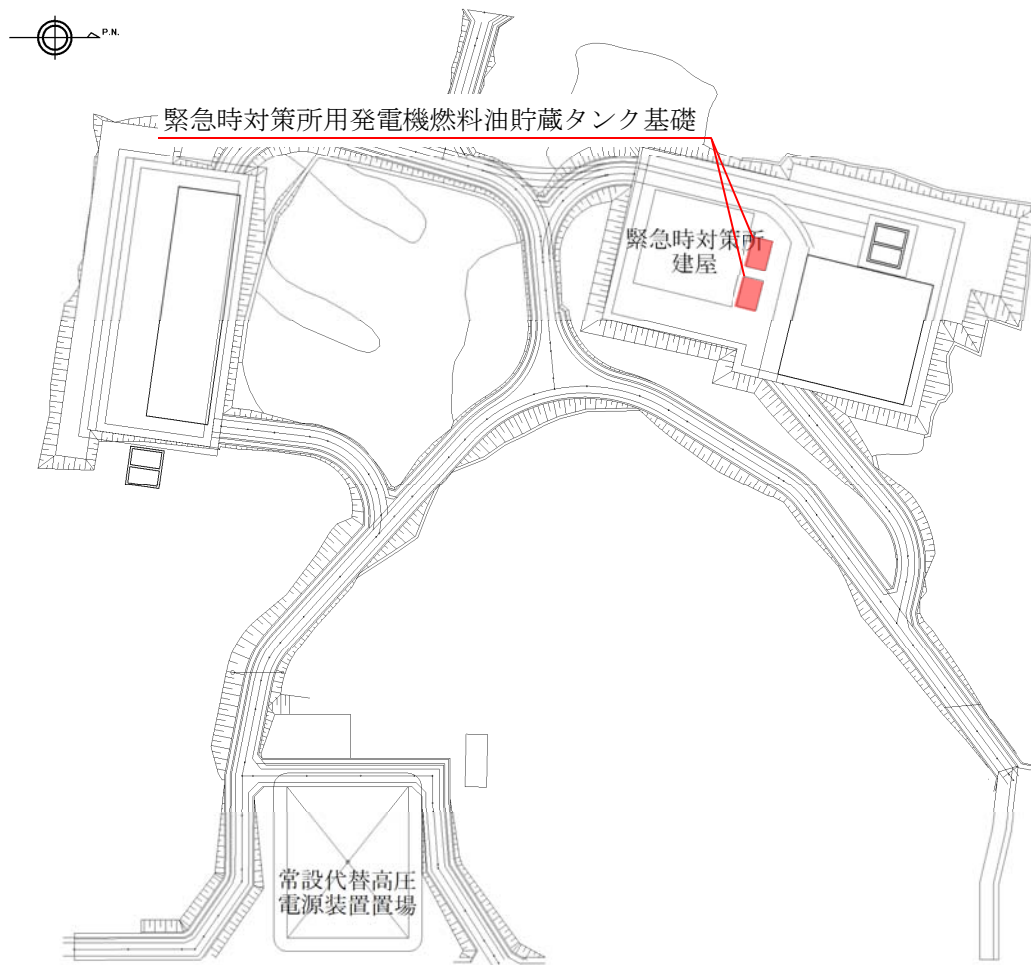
緊急時対策所用発電機燃料油貯蔵タンク基礎の位置図（全体平面図）
